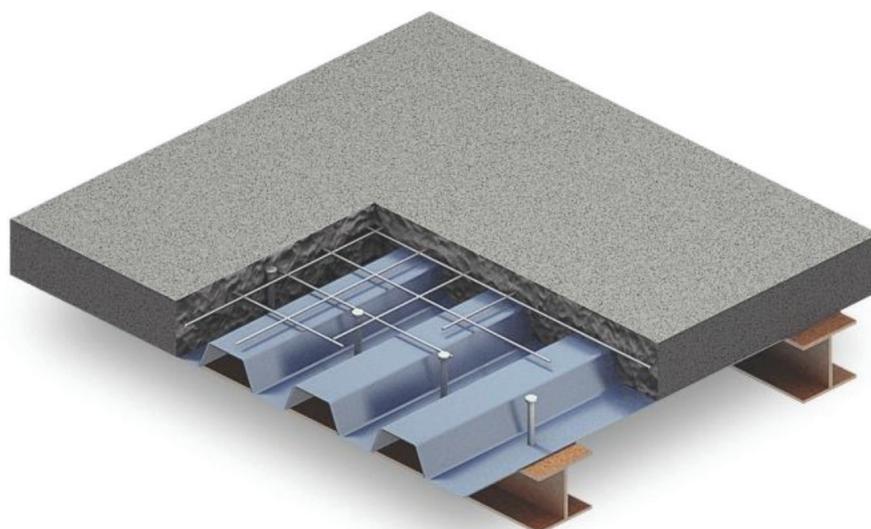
Exemplo de laje mista sobre viga metálica – Steel deck
